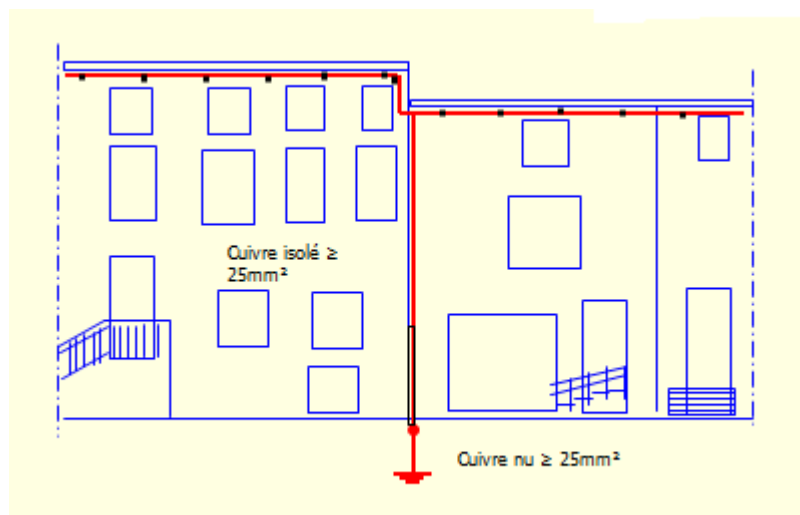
schéma de mise à la terre de neutre sur façade [6]
